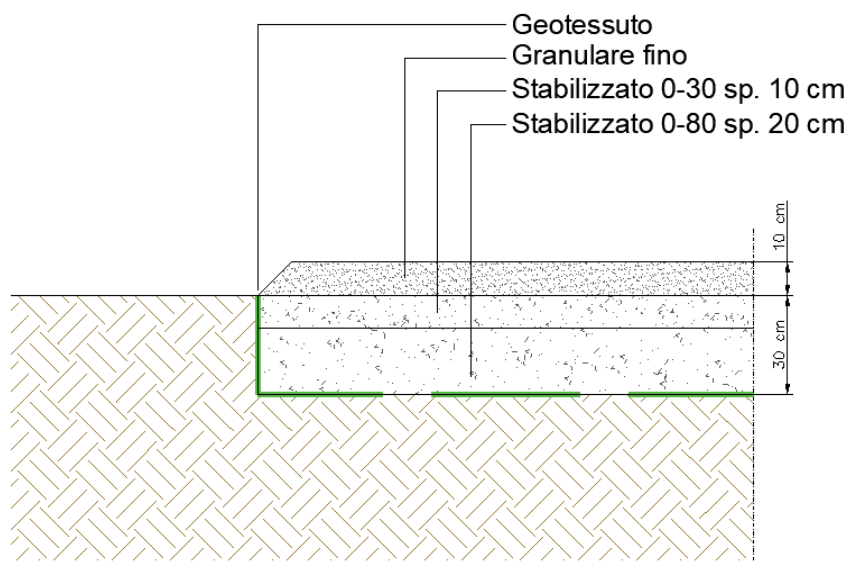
Sezione tipo viabilità interna all'impianto e piazzali
